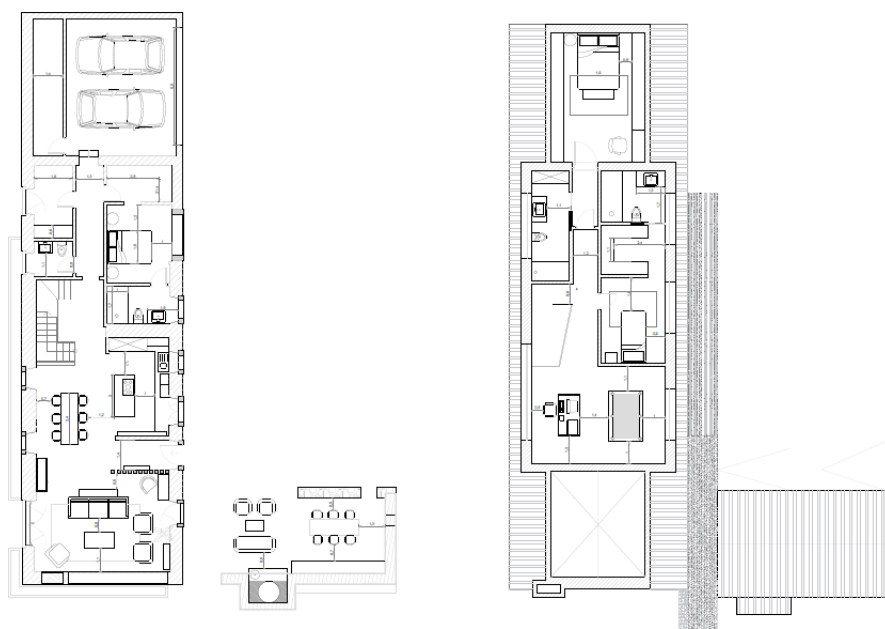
Proposta Final Fonte: Jacinta Vaz, 2023
